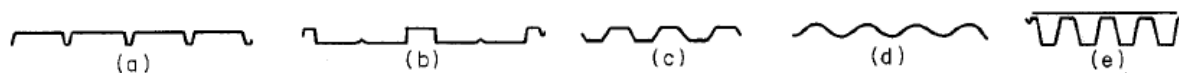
Painéis ou chapas perfiladas em aço enformado a frio (Yu, 2000)
